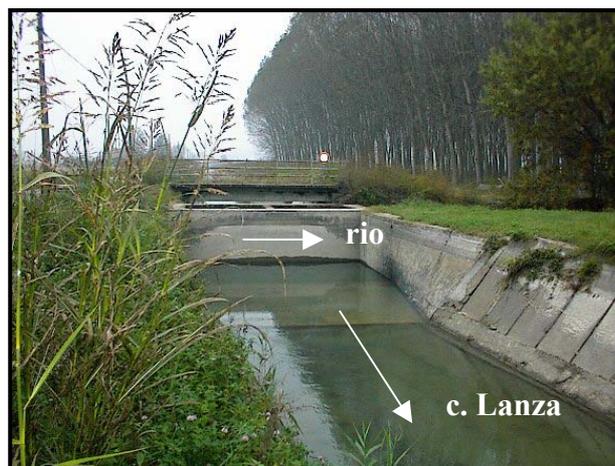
Vista da valle del ponte sul Lanza e del ponte canale.
